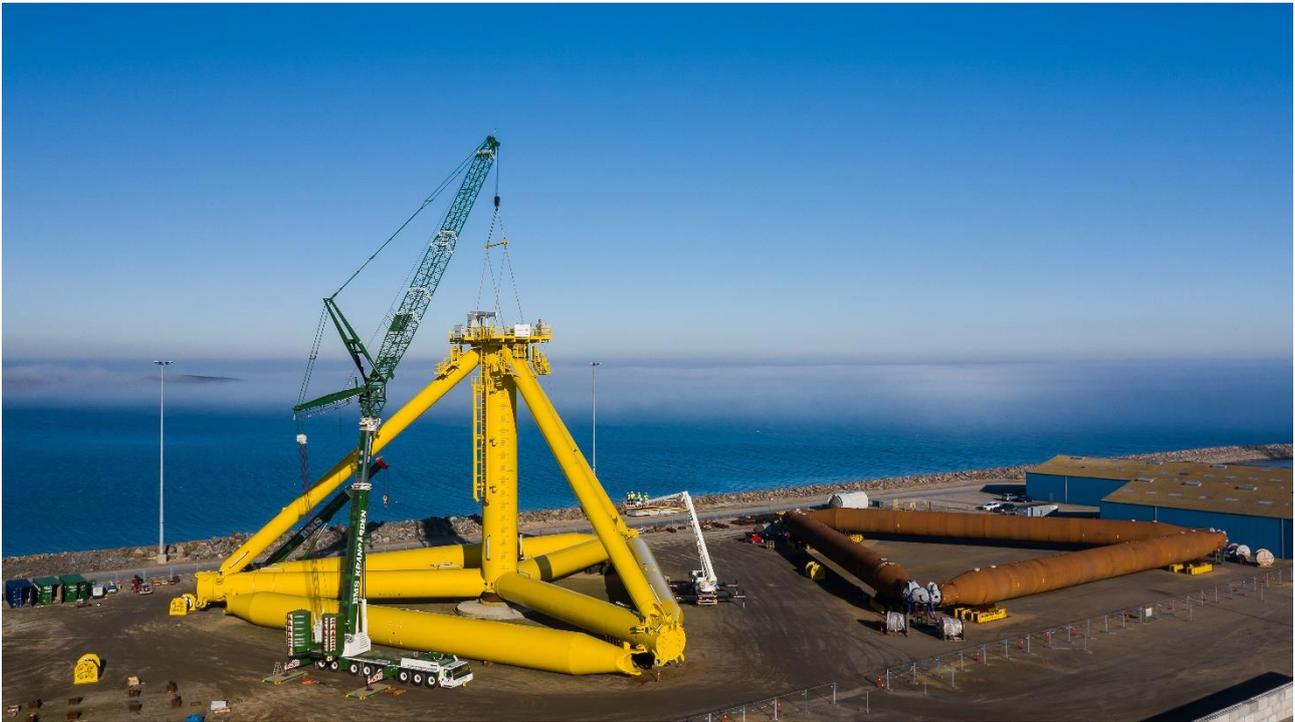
Fasi di assemblaggio della fondazione galleggiante *TetraSpar
